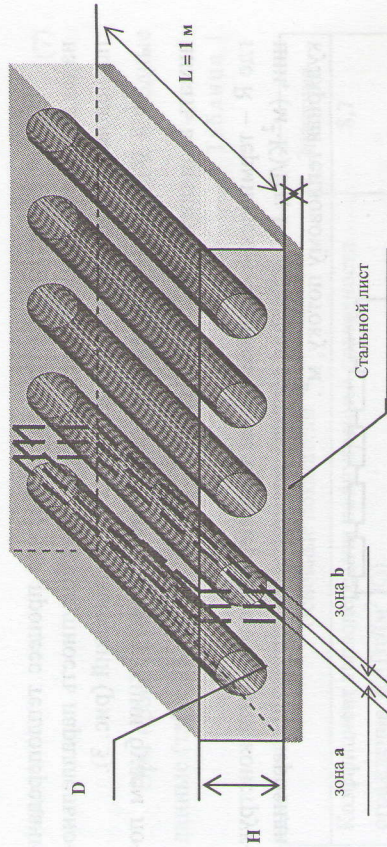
Схема поперечного сечения плиты перекрытия с продольными пустотами цилиндрической формы
